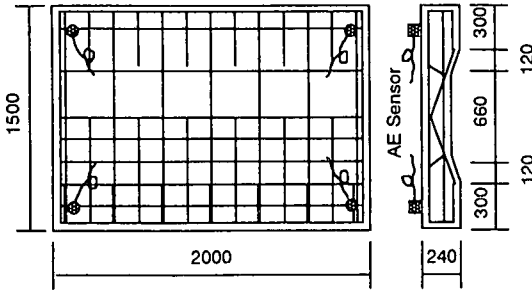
鉄筋コンクリート床版供試体および AE センサー配置
